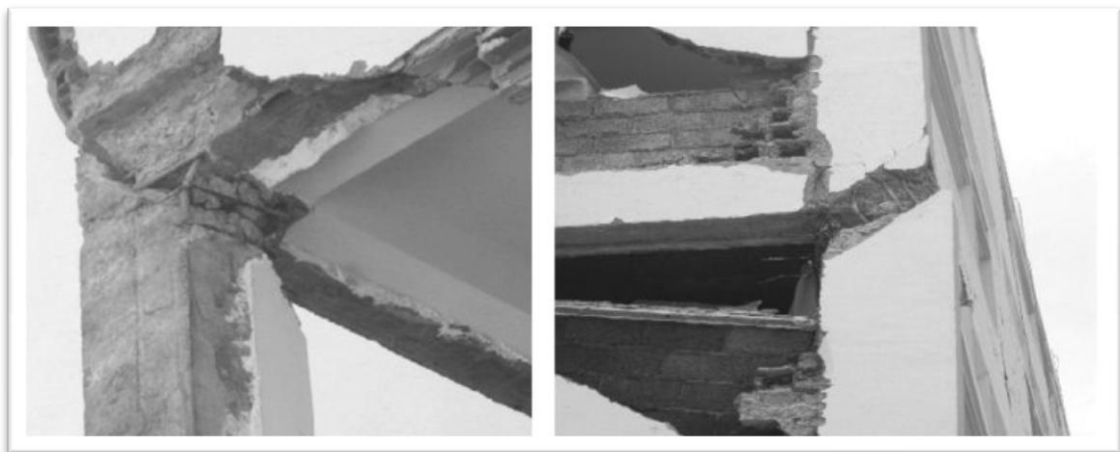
cisaillement des poteaux par les bielles développées dans la maçonnerie insérées
